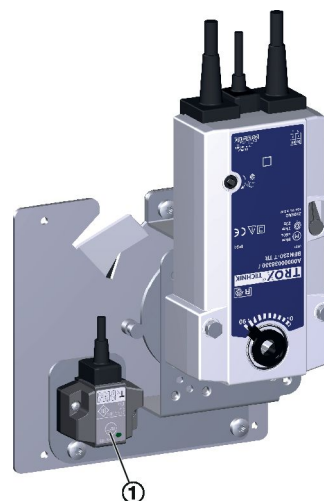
Funksjonstest (FKA2-EU med BFN aktuator vist i ÅPEN stilling)
